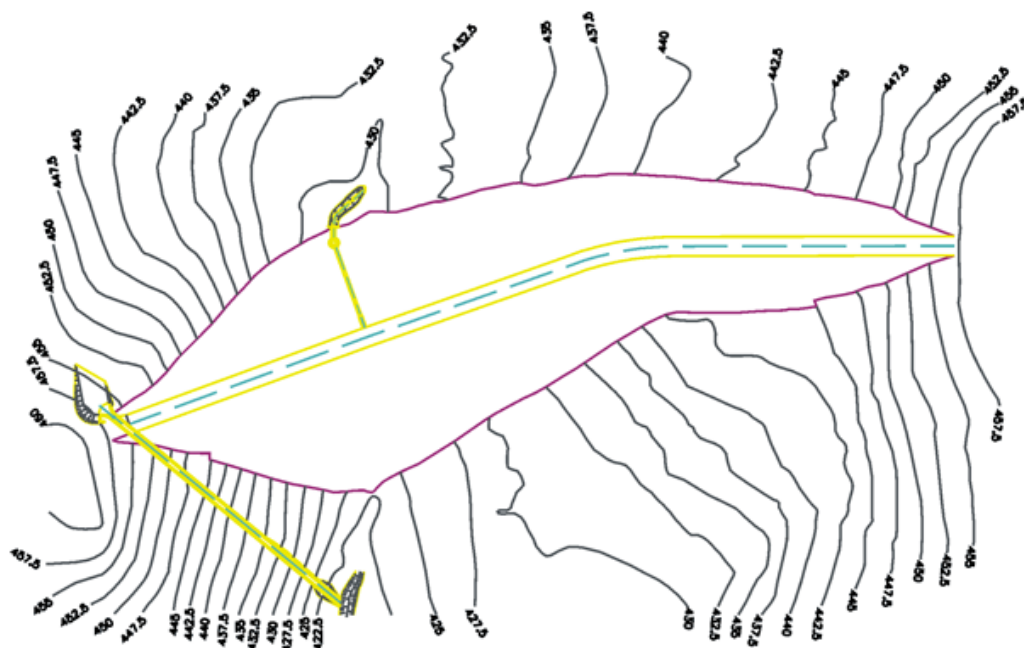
Vista em planta da barragem de Rego do Milho.
